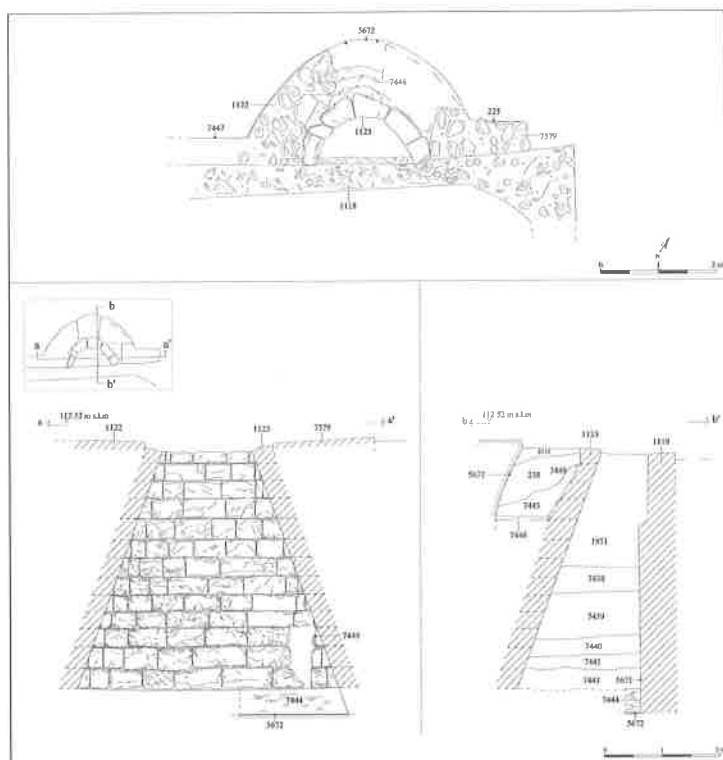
Pianta, sezione stratigrafica e prospetto della cisterna C
